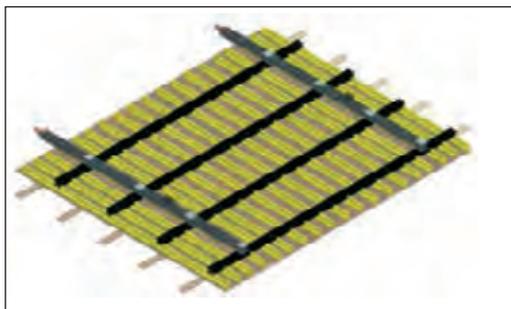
Posicionamiento de viga principal (vela) en encofrado de forma
